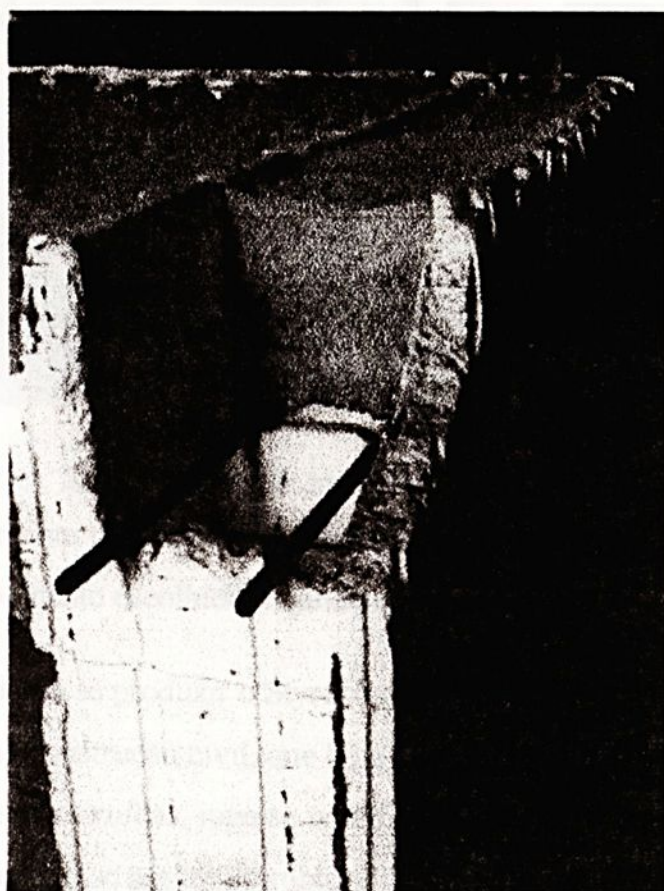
Detalhe da ferragem e do concreto interno do Styrobloc
